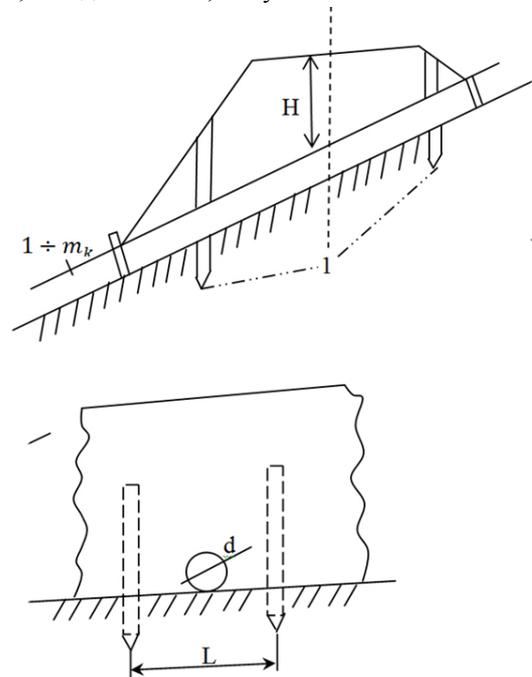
Укрепление водопропускной трубы и насыпи земляного полотна сваями – 1.
